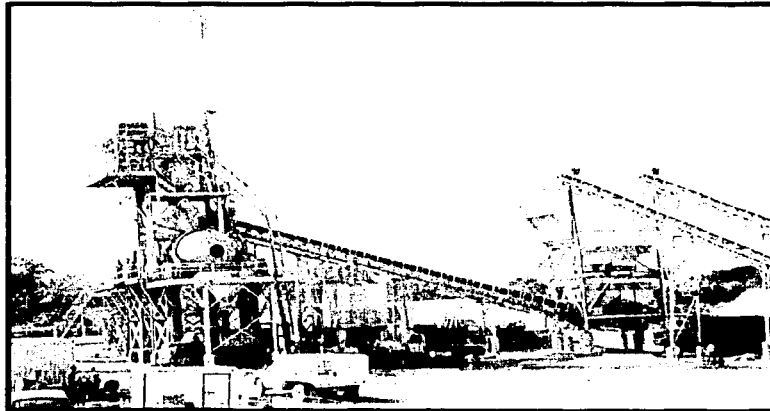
Planta de mezclado central de las compañías concreteras, elaboración del concreto para proyectos de pavimentación (pisos industriales)
